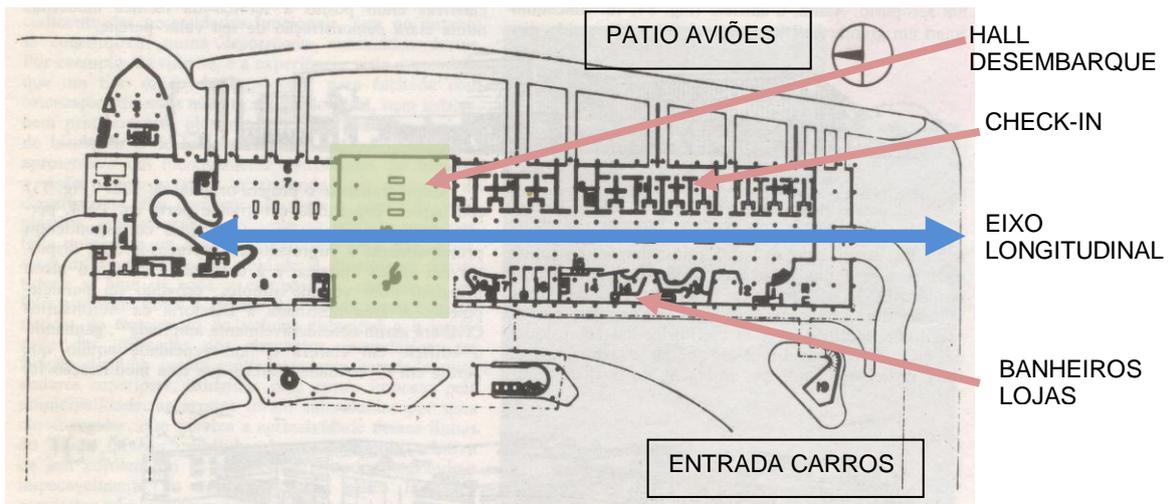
Planta baixa do primeiro pavimento do terminal de passageiros do Aeroporto Santos Dumont (1938-44)
